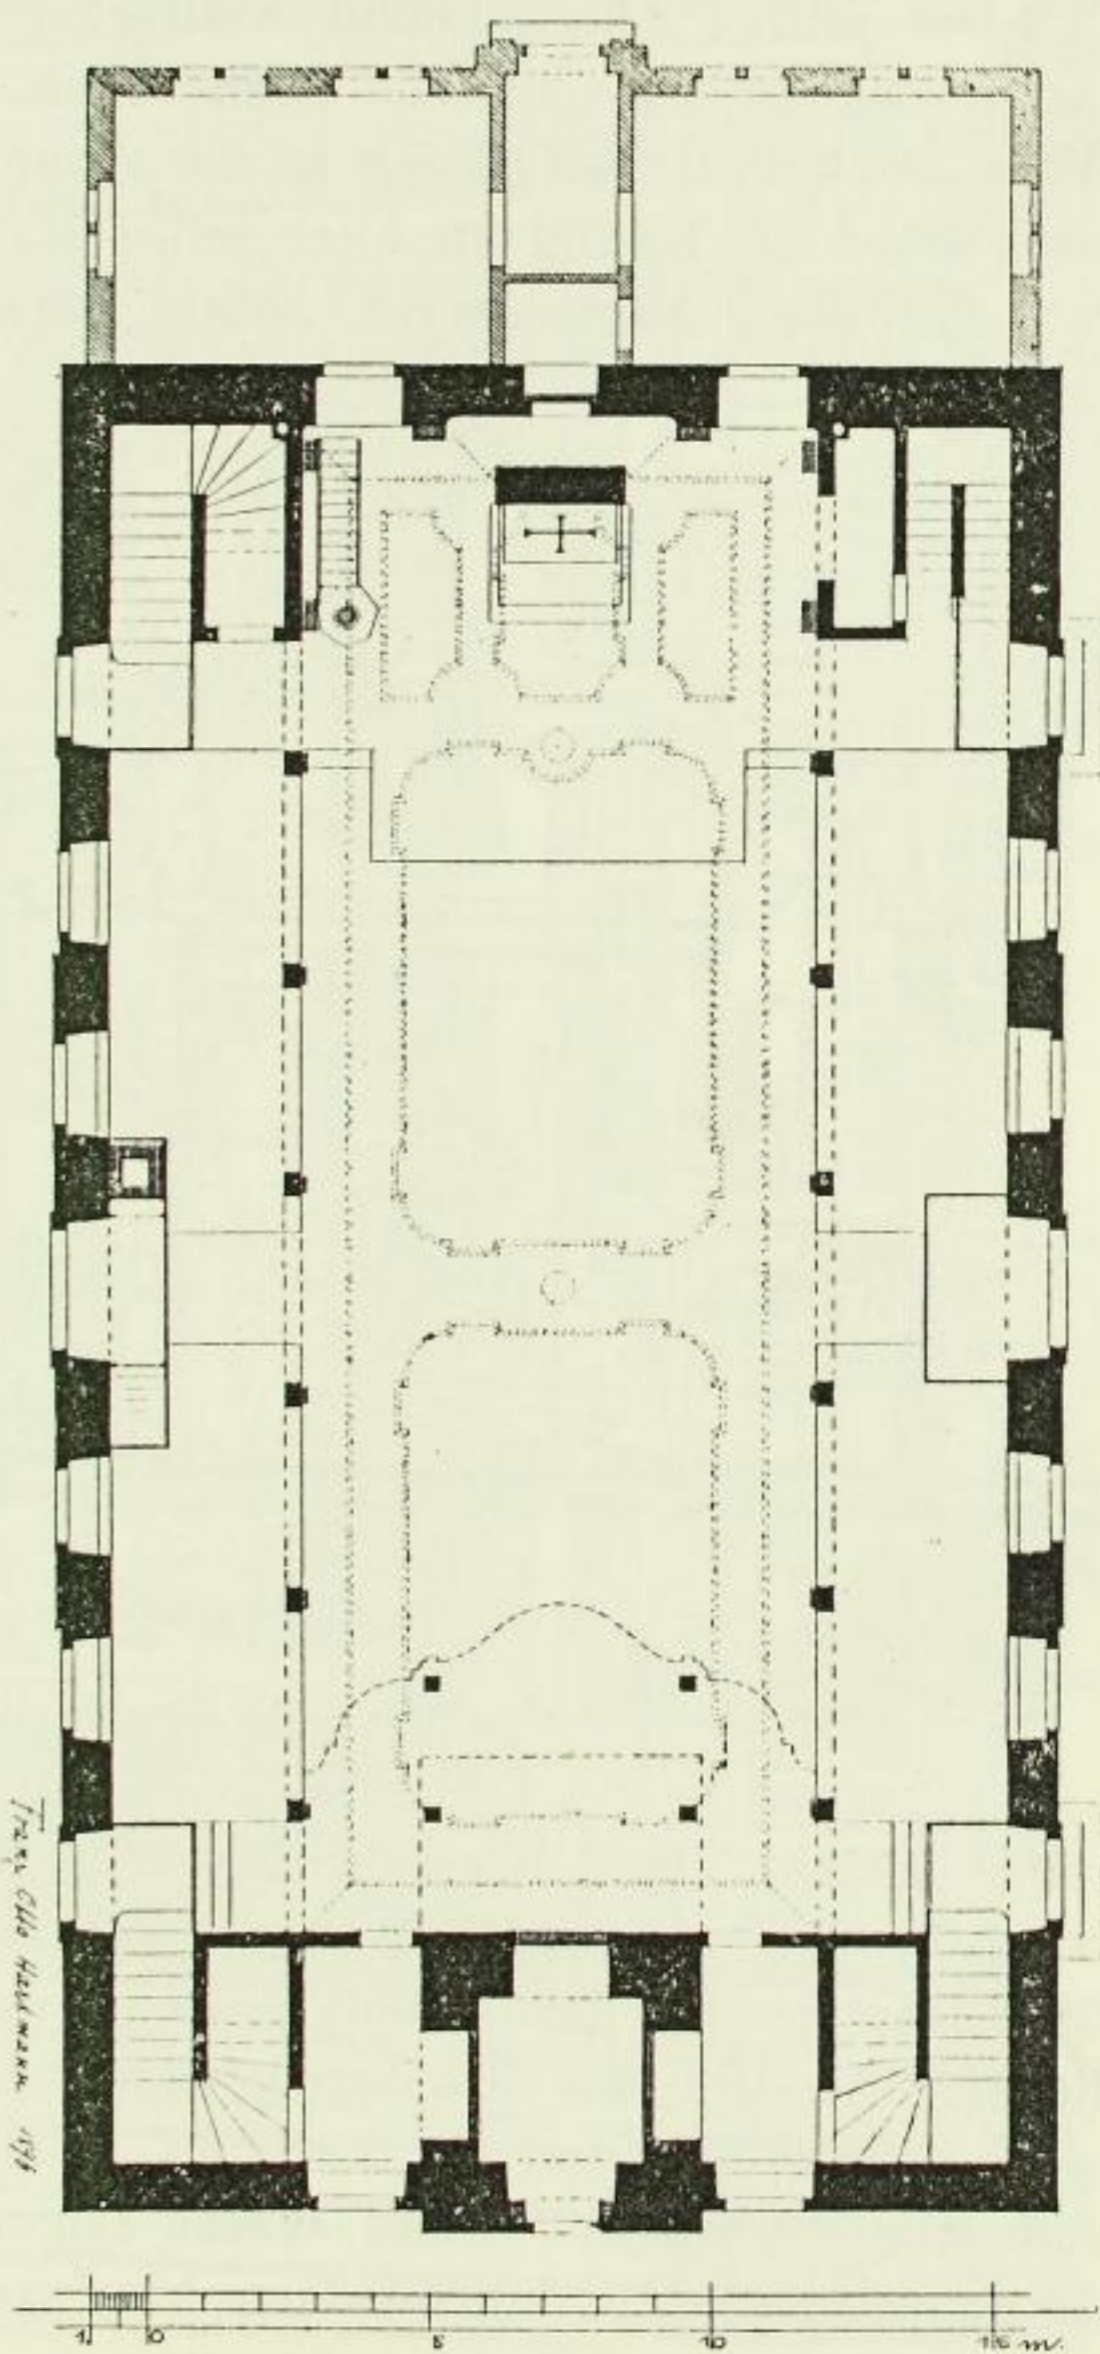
Friedrichstädter Kirche, Grundriss.
